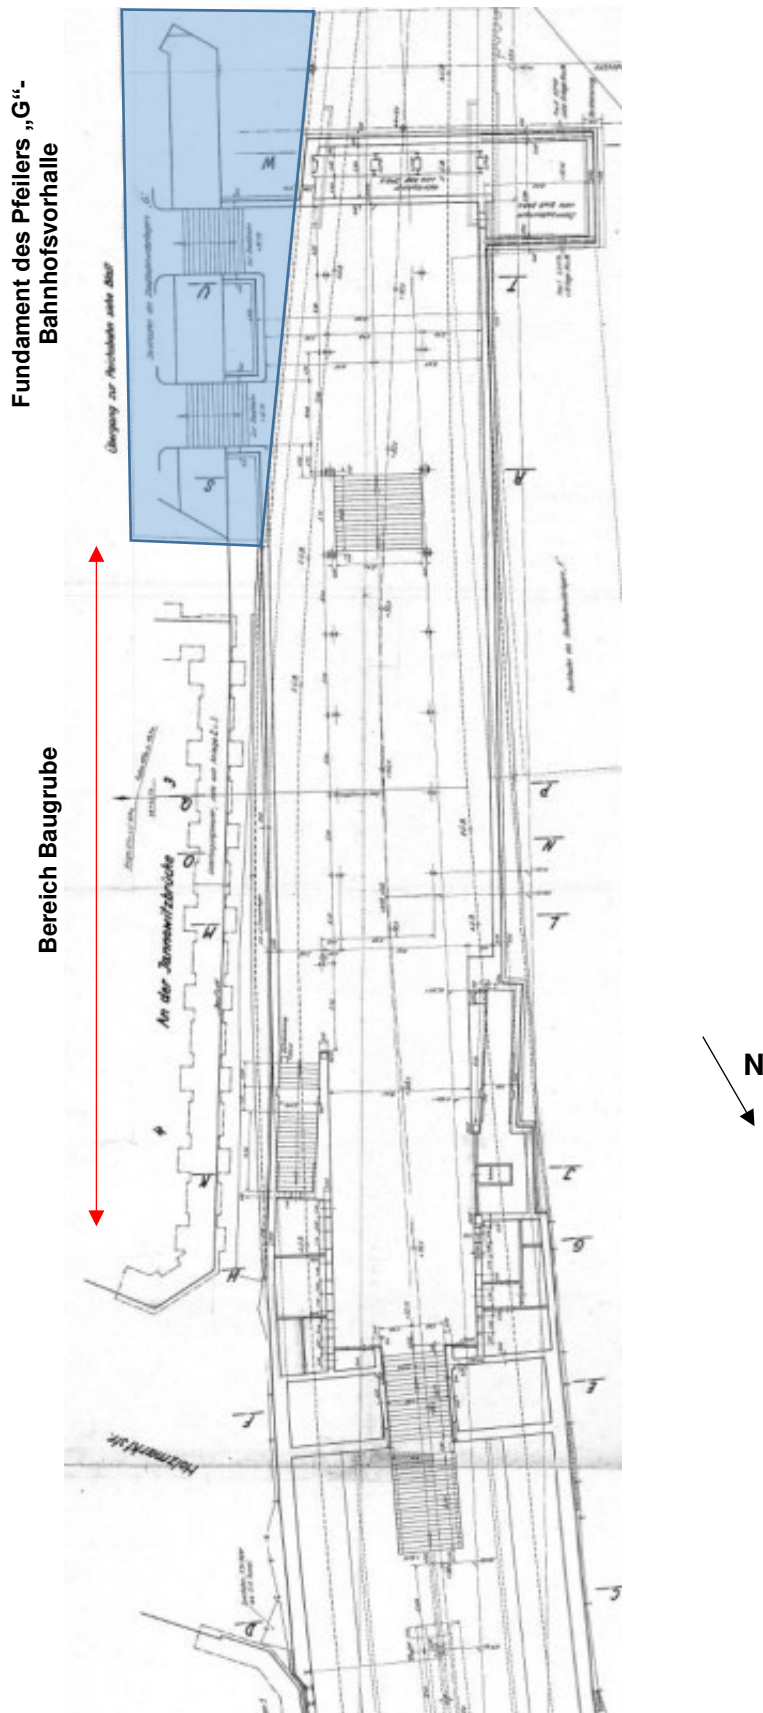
Grundriss U-Bahntunnel U8 im Bereich zwischen Holzmarktstraße und der Spree aus [U 12]
